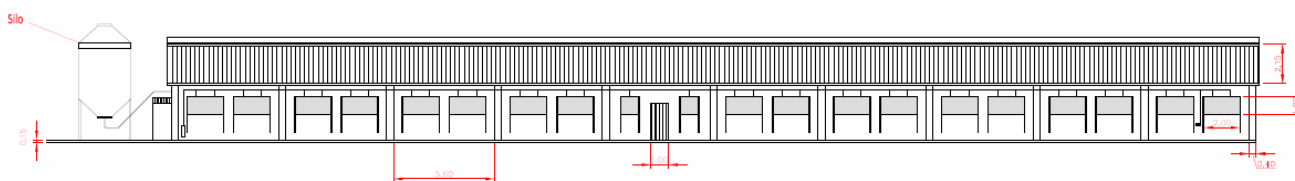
Alzado lateral Sur Nave 1 y Norte Nave 2
